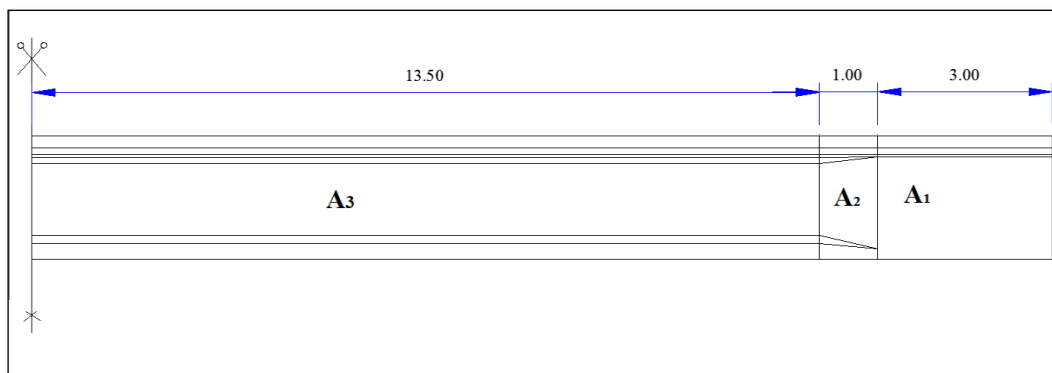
La variation de la section de la poutre suivant le sens longitudinal
